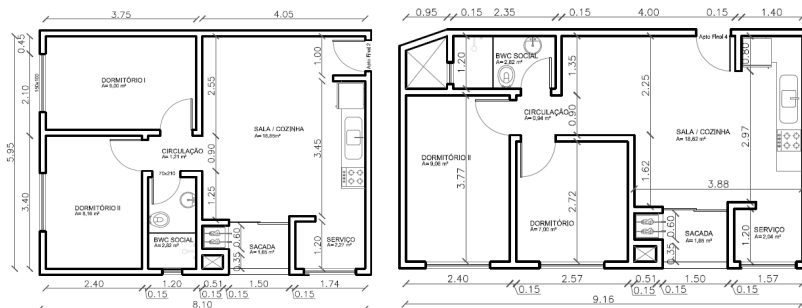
Plantas baixas técnicas. a) Apartamento Tipo a, b) Apartamento tipo b.
